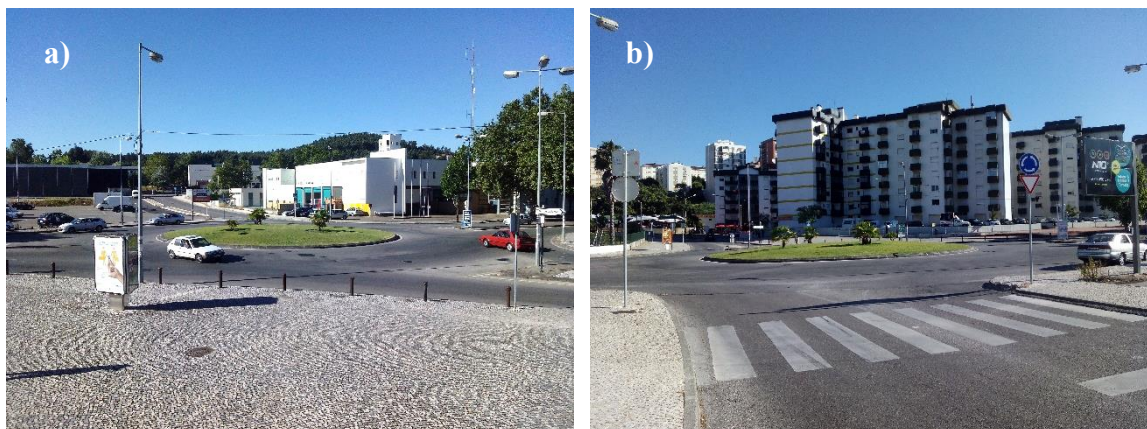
Rotunda em estudo: a) vista entre as entradas C e D; b) vista da entrada B
